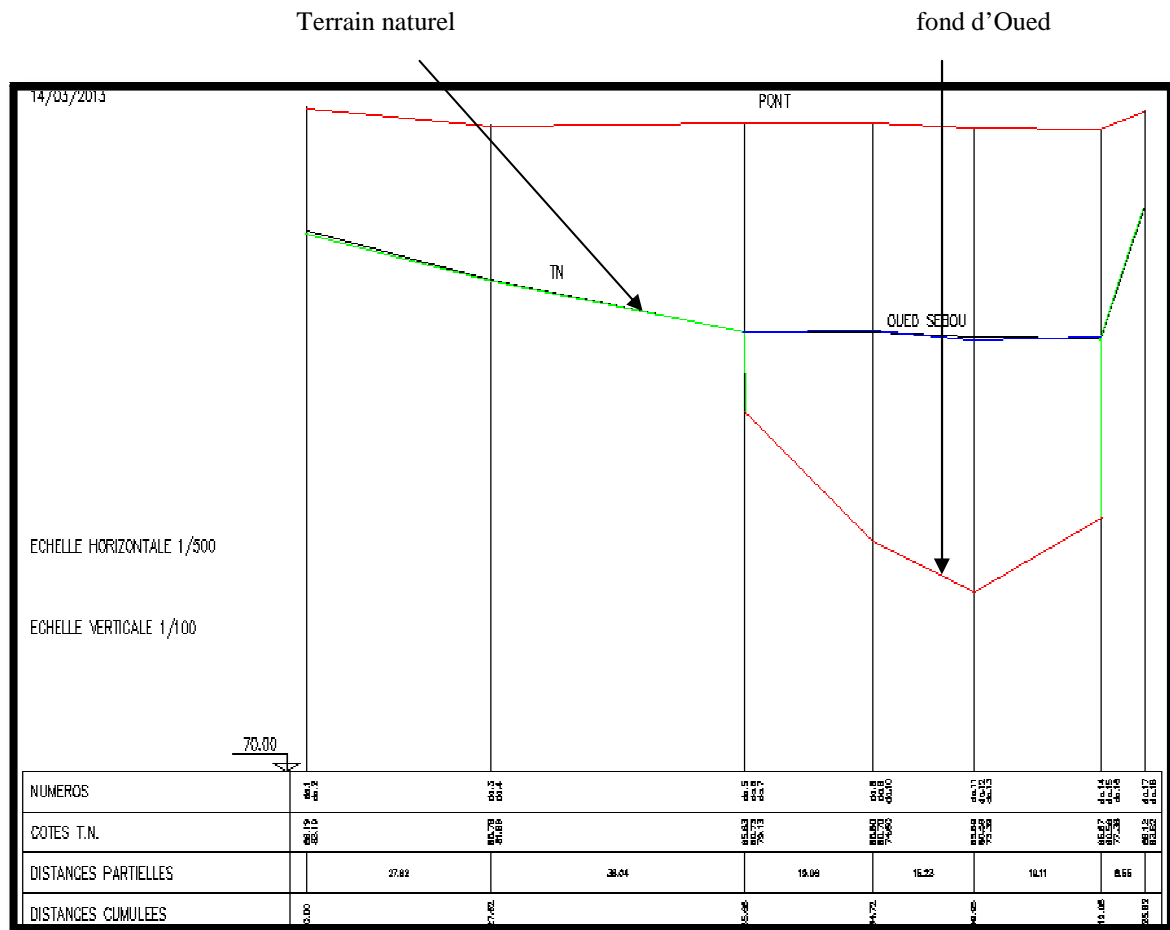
Le profil en travers de la coupe 1 d'Oued Sebou
